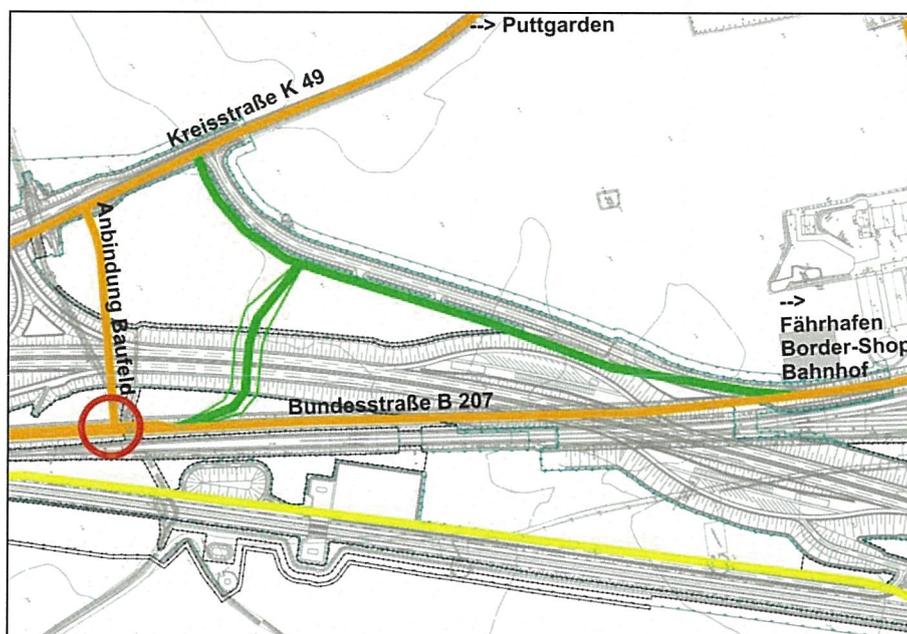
Bau Umleitung B 207 – Anschluss an Hafen
